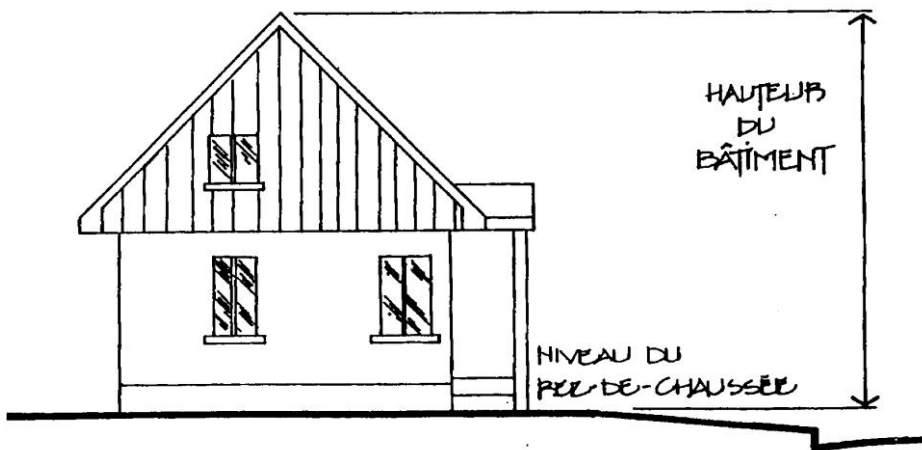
Hauteur minimale et hauteur maximale – cas 2
